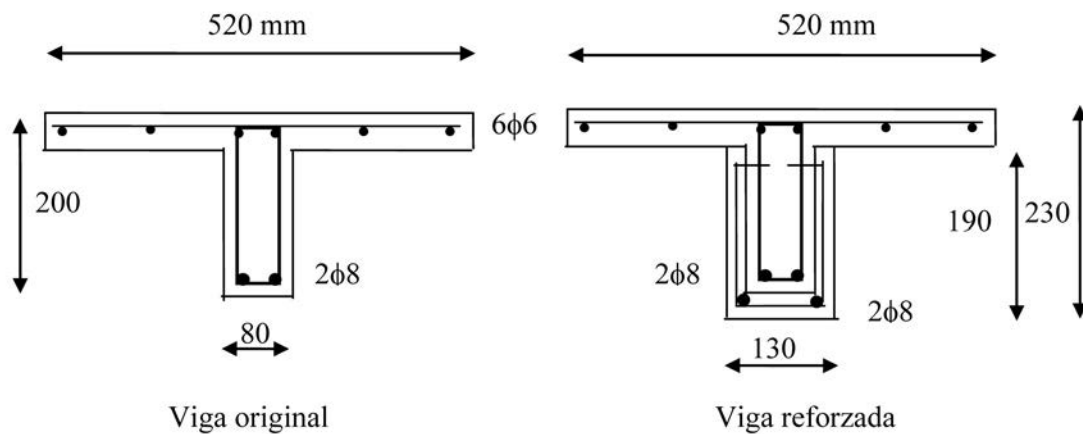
Sección transversal y armadura de la viga original y reforzada.
